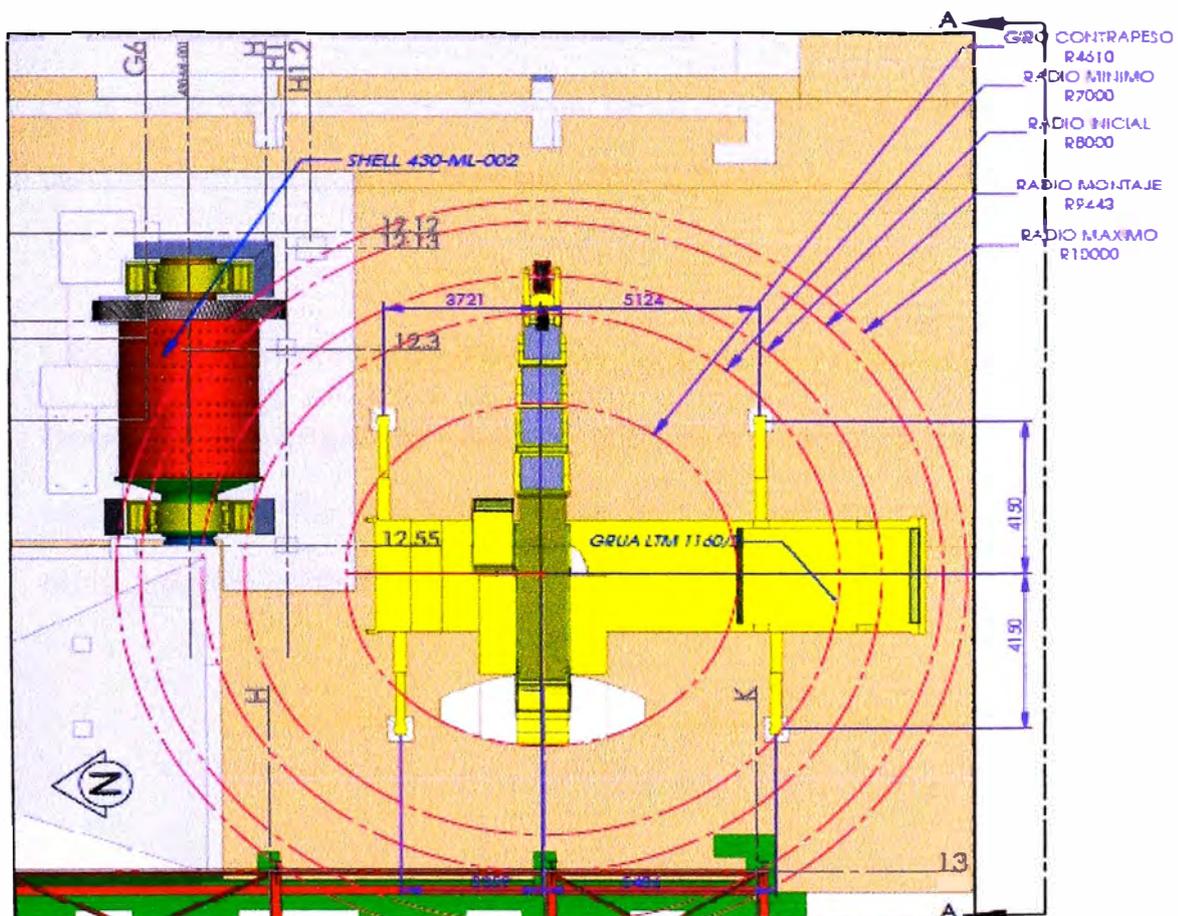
Vista de planta del rigging plan – montaje de shell
